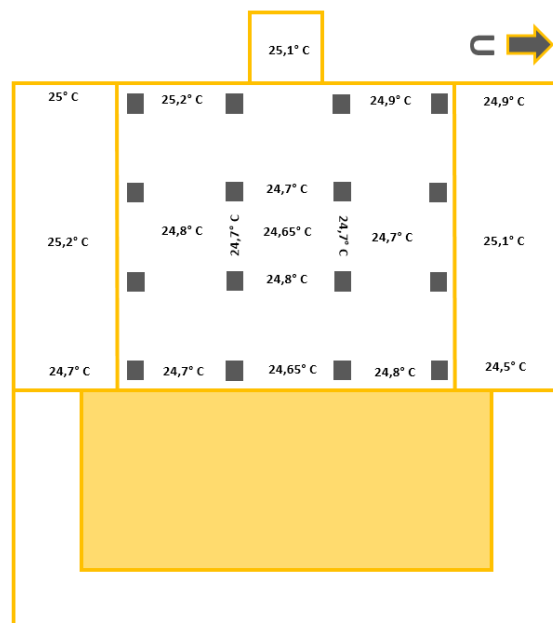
Lantai berundak yang mampu menurunkan suhu (Sumber : Dokumen Penulis, 2019)
